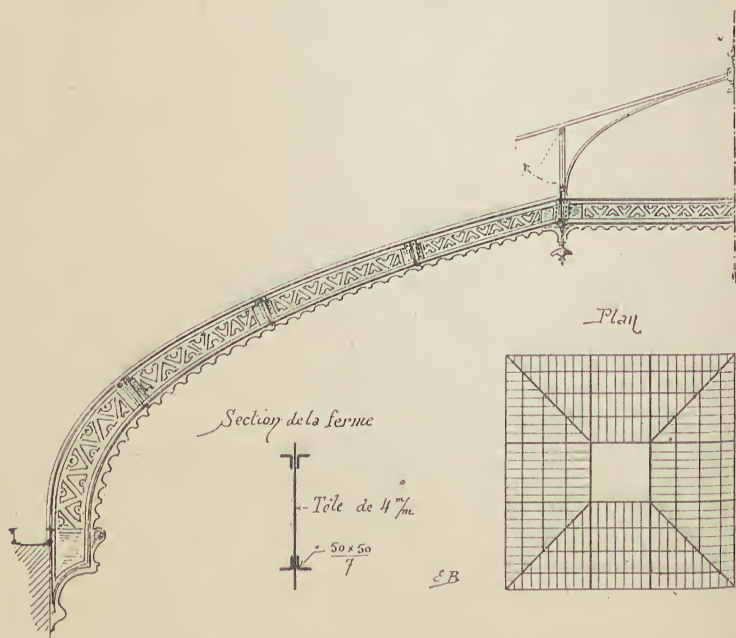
, 1045, 1046. — Comble sur plan carré.
